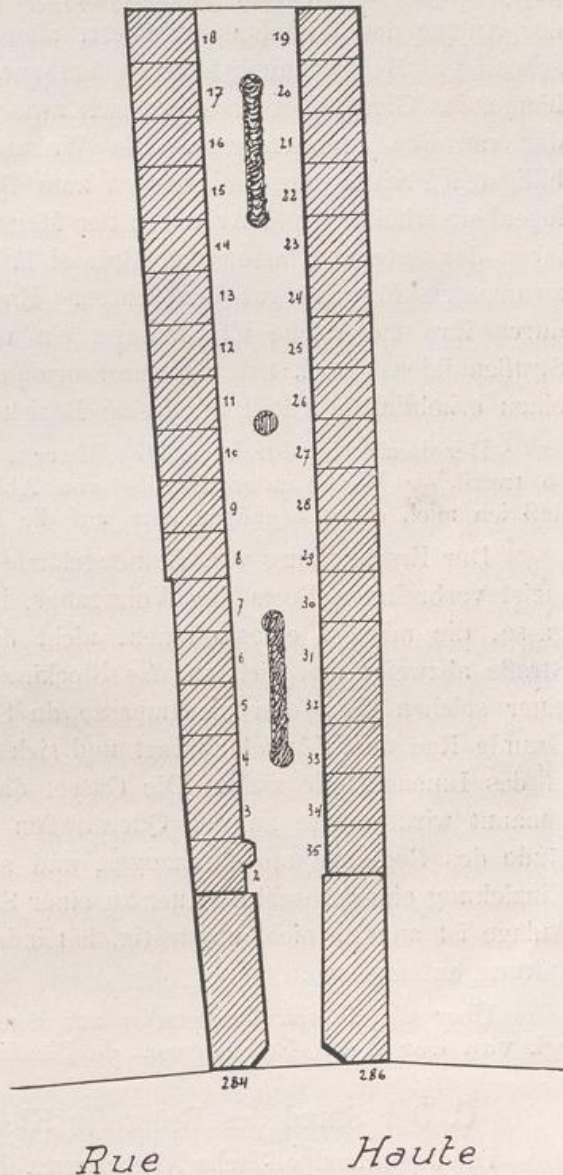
Impasse Defuisseaux, Grundriß. Maßst. 1:650.
